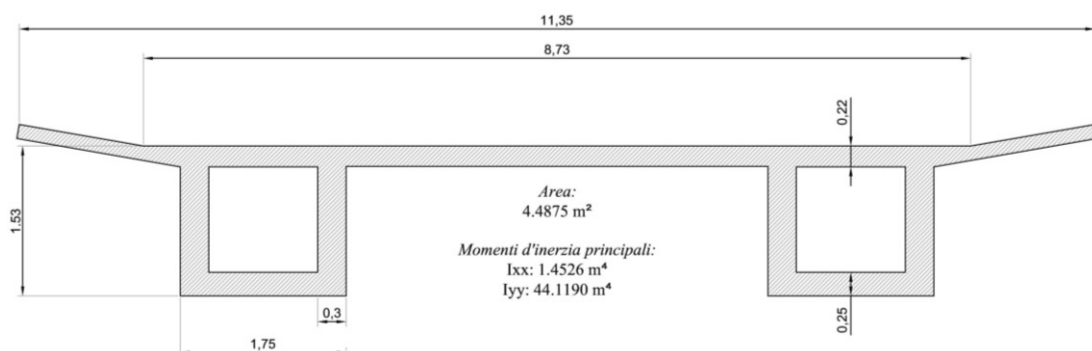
Sezione trasversale ponte sul nuovo canal salso post-retrofitting
